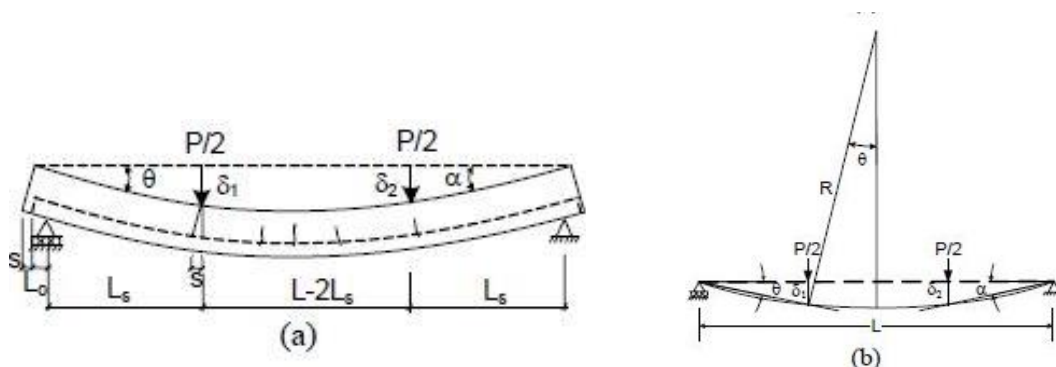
Fissuração da laje ensaiada (a); Deslocamentos e curvatura da laje ensaiada (b) (adaptado [18])
